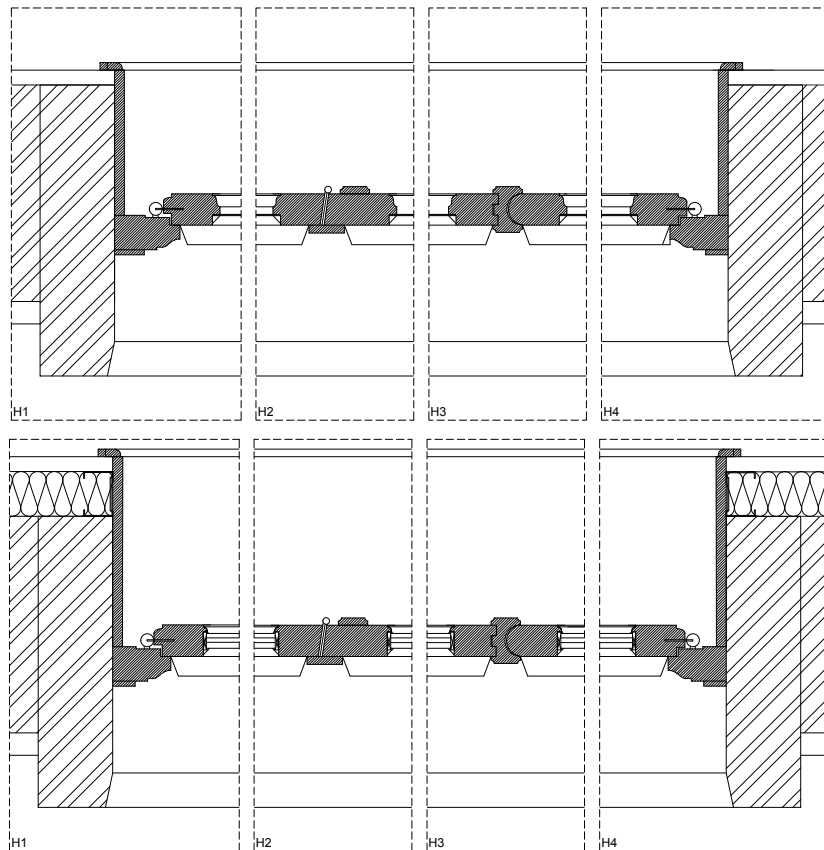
VE2 | Levantamento e proposta | Planta | Escala 1.10
